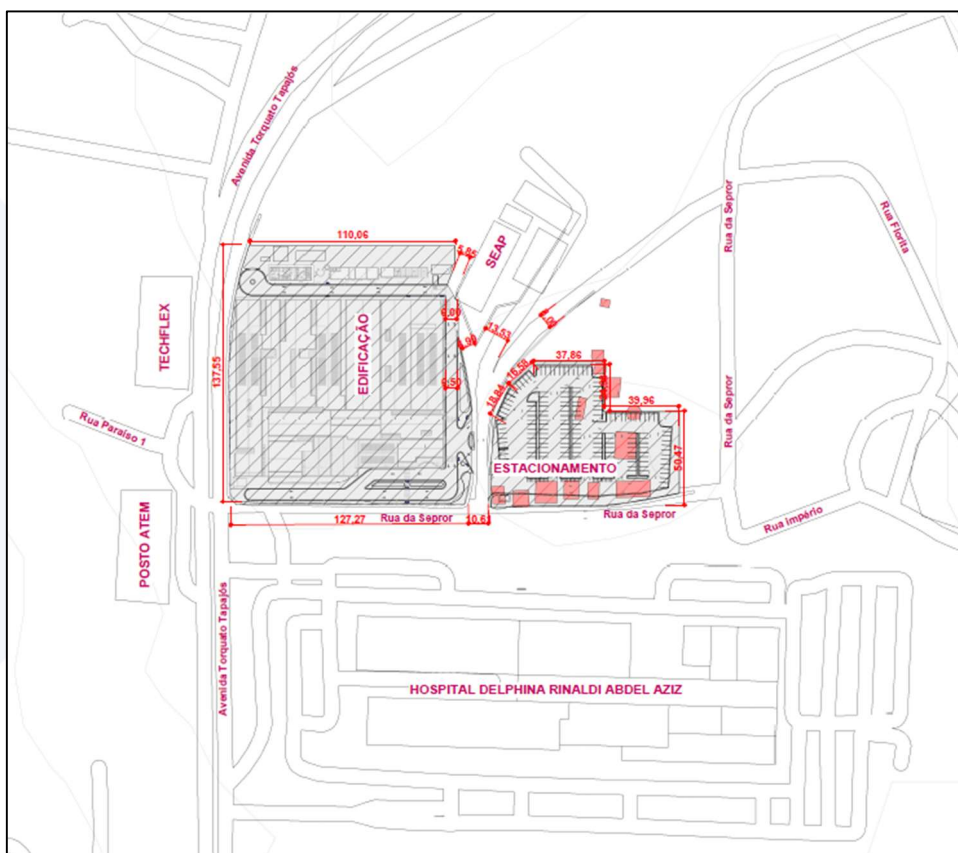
Planta de Localização do Empreendimento. Fonte: Projeto de Localização, 2025.
